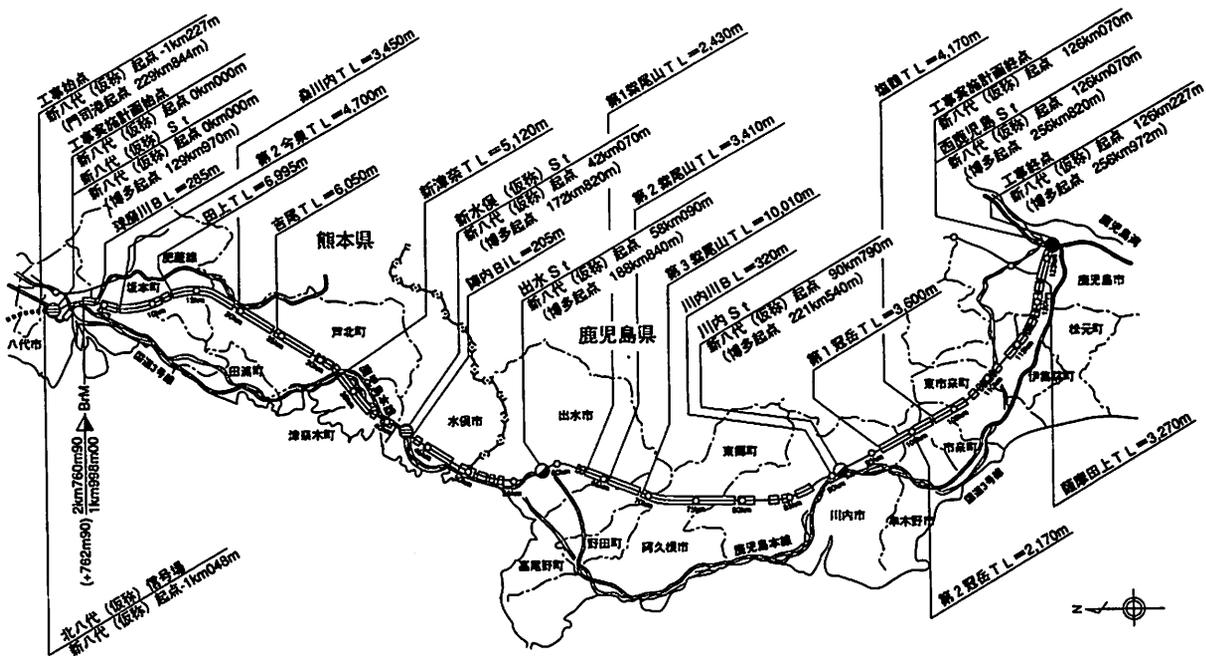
九州新幹線新八代(仮称)・西鹿児島間線路平面図
